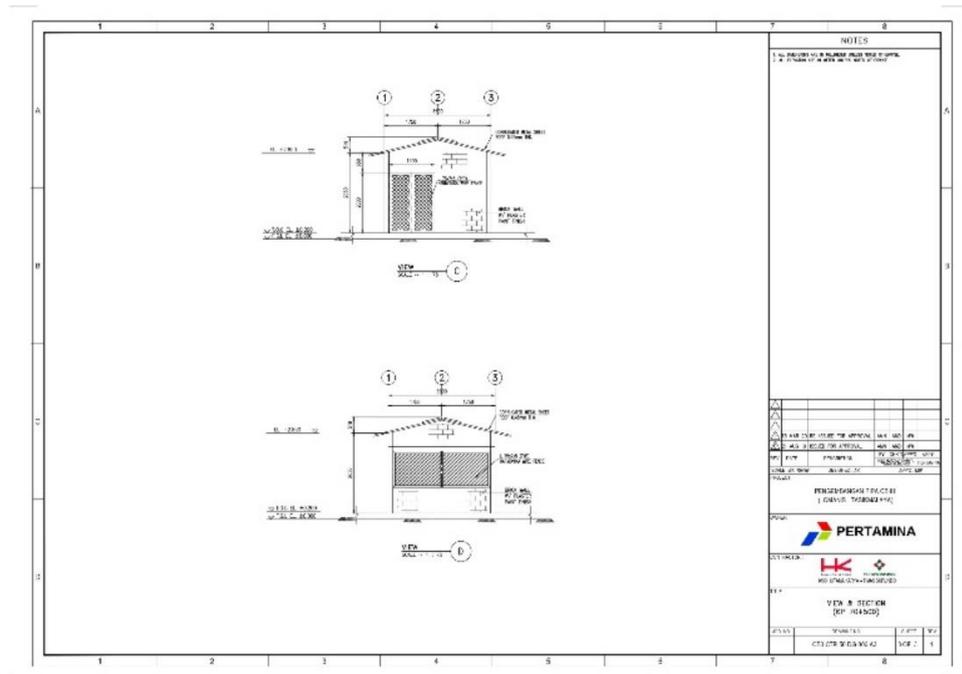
Plan Layout dan Detail Block Valve KP 77+500 (Sumber : Dokumen Perusahaan)
